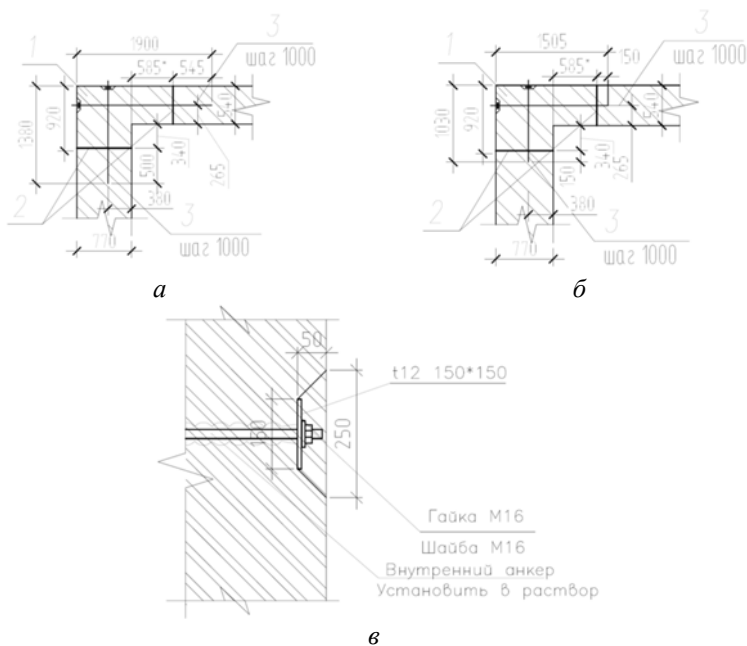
Усиление стены с трещинами в углах здания или в примыкании поперечных стен к продольным: *а* – схема, согласно [2], *б* – схема для Hilti, *в* – деталь анкеровки: 1 – усиливаемая стена; 2 – трещины в кладке стены; 3 – внутренний анкер [2]
